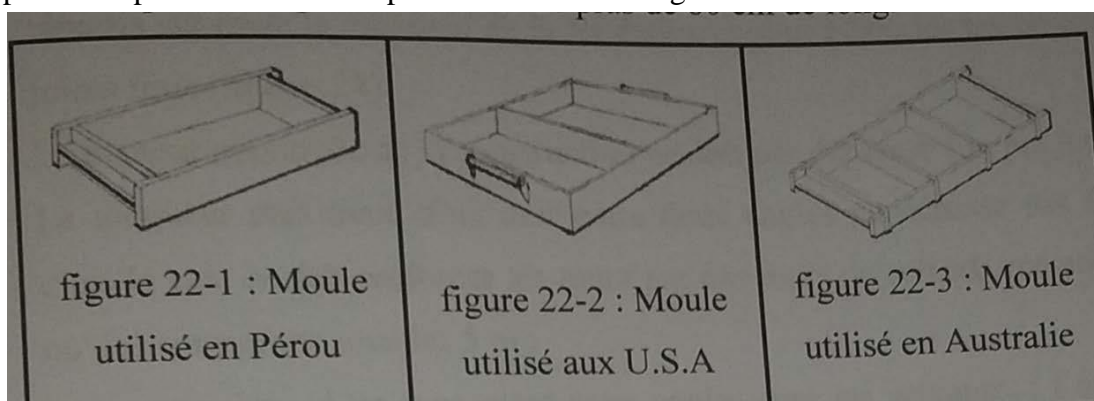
exmples des moules des gronde dimension(source CRTerre p115-116)
